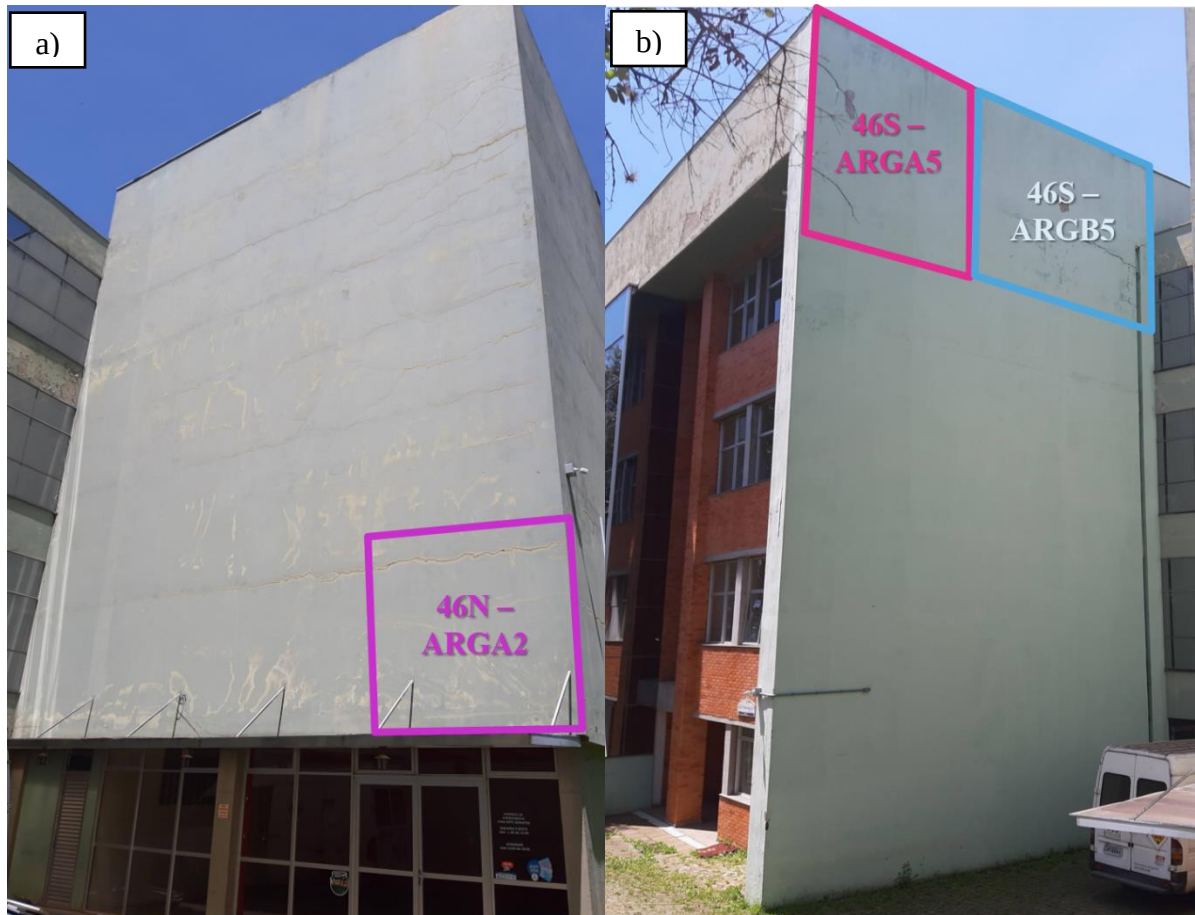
Nomenclatura das áreas de fachada do restaurante universitário a) ao sul b) ao norte
